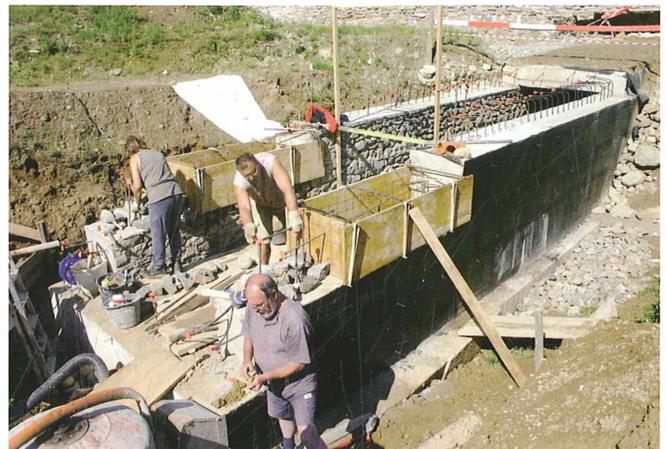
West-Cavea. Arbeiten am unterirdischen Gladiatorengang bzw. Aufgangsschacht in die Arena. Im Vordergrund Schalung zur Rekonstruktion der Wände, dahinter Stampfbetonmauern mit Armierung. Blick aus Osten. Aufn. R. Barlovits
